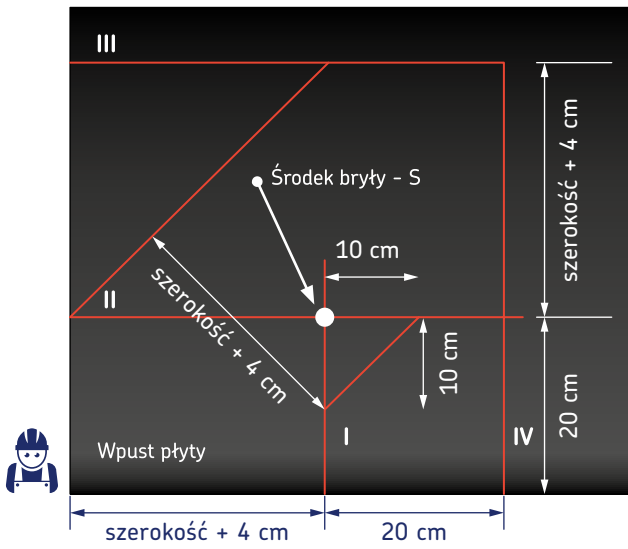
• Rozrys pokrywy kolana dla płyty 25 mm
